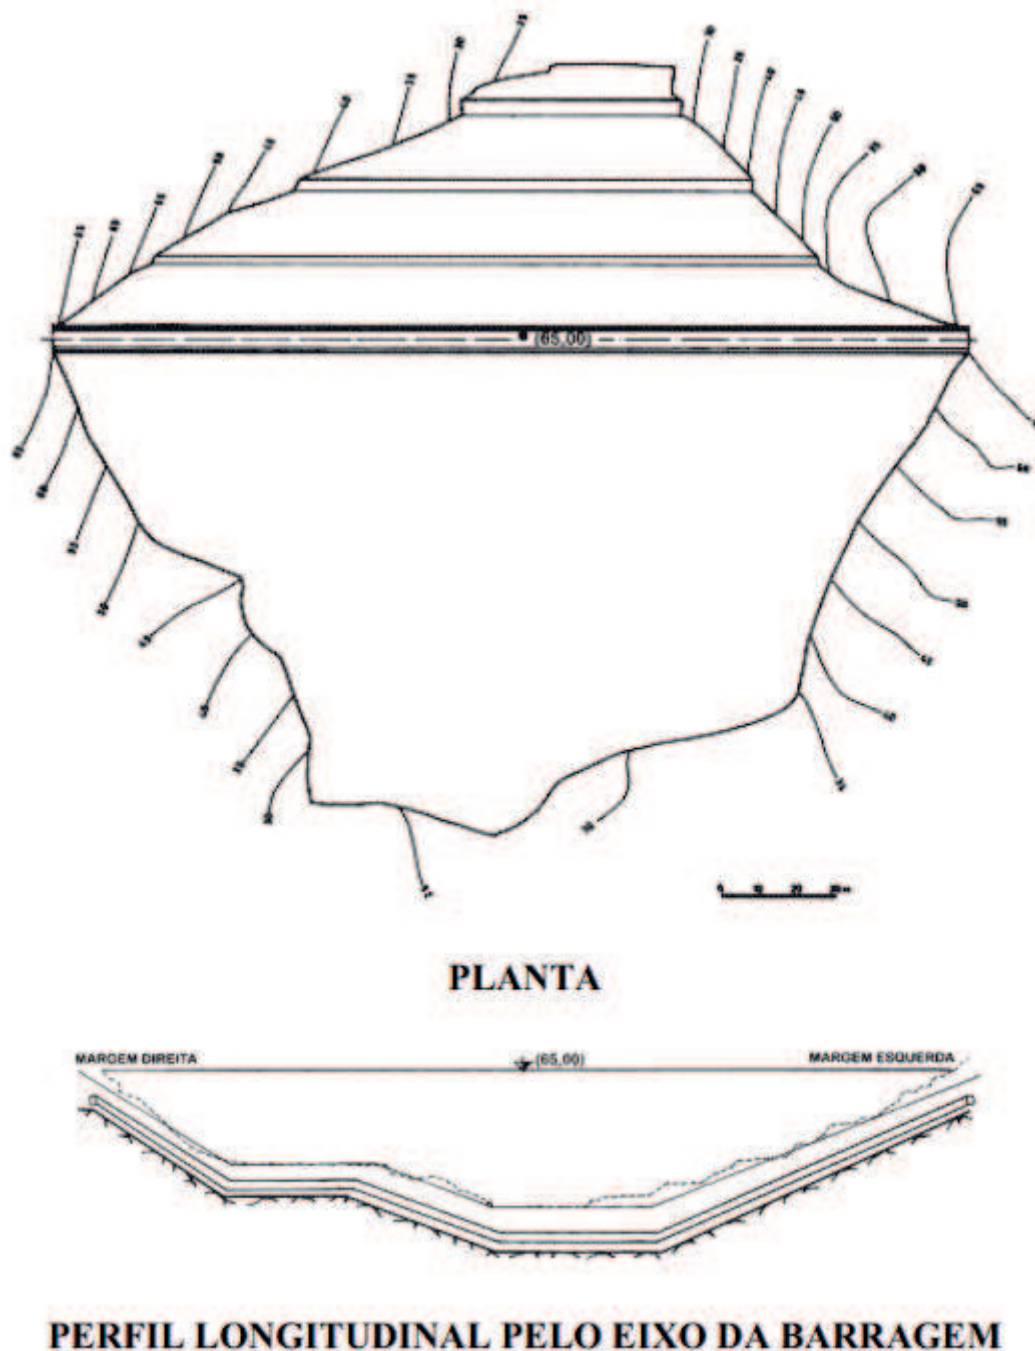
Projeto Barragem de Silves (Planta e perfil longitudinal), (<http://sir.dgadr.pt>).
